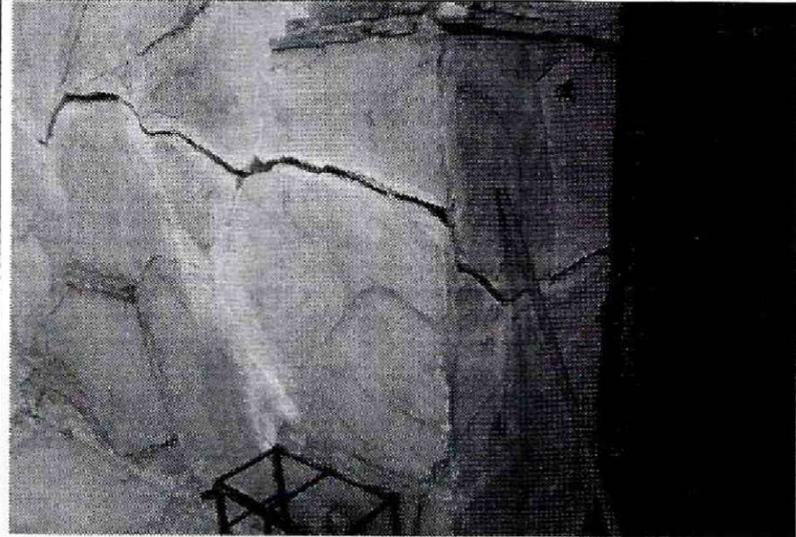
Agrietamiento de la fachada en del sector cercano a la puerta de ingreso.
